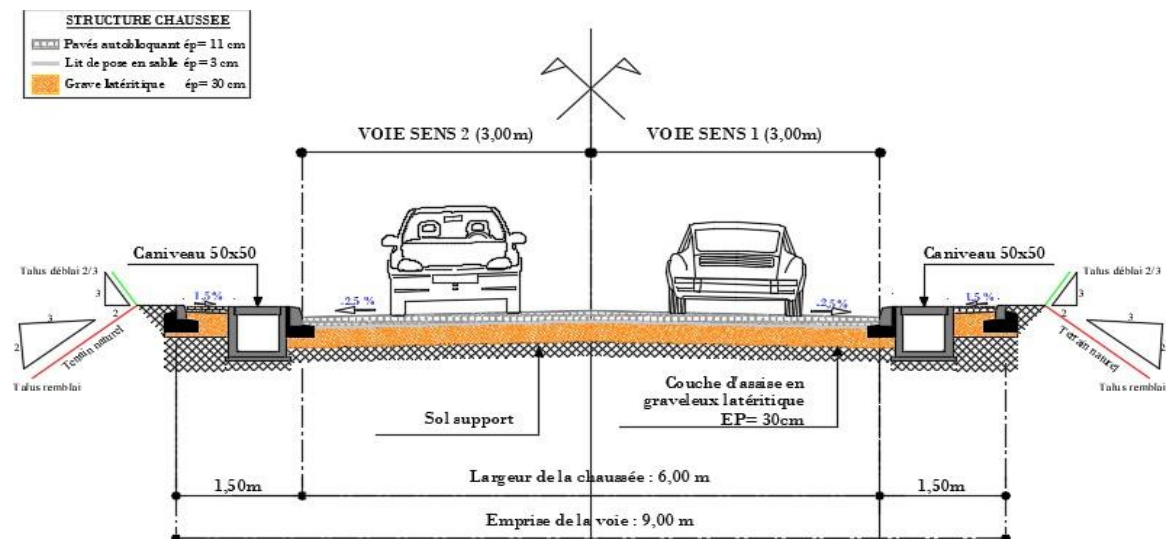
Profil en travers type 3 pour la première bretelle (chaussée de 6,00 m)
